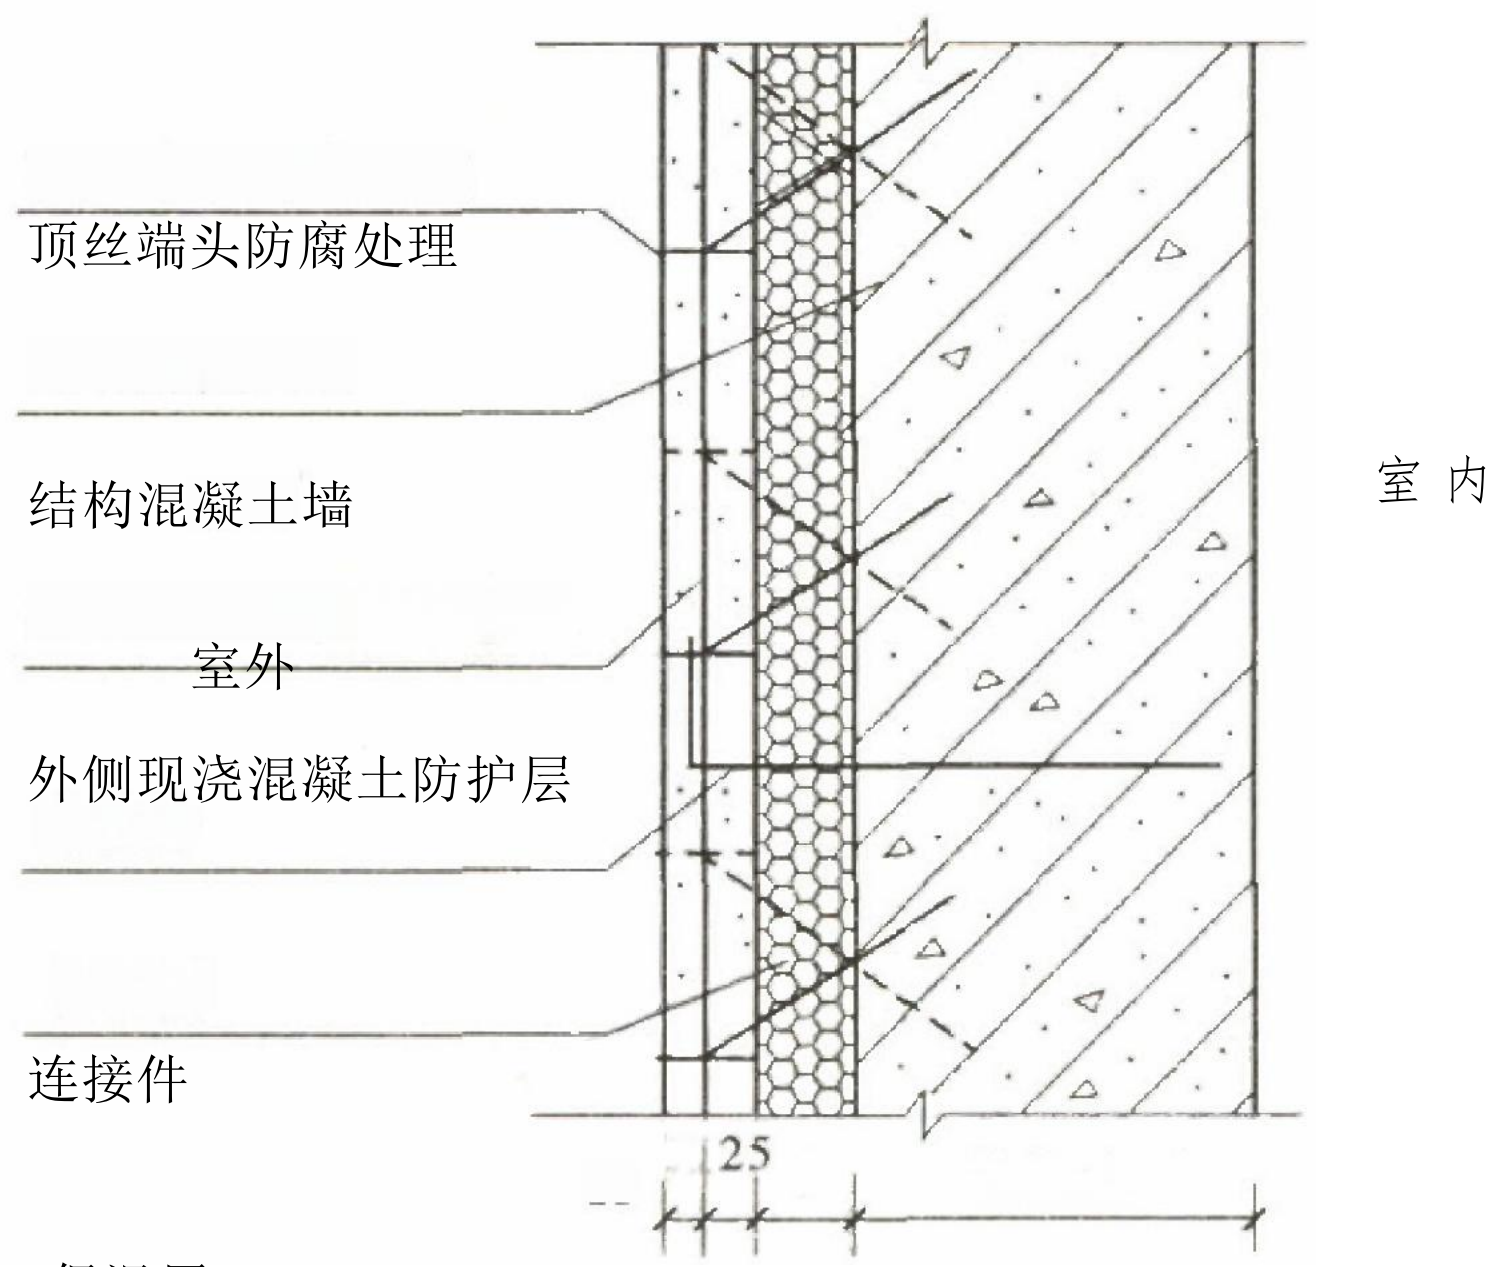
现浇混凝土内置保温墙体构造示意图 (单位: mm)
